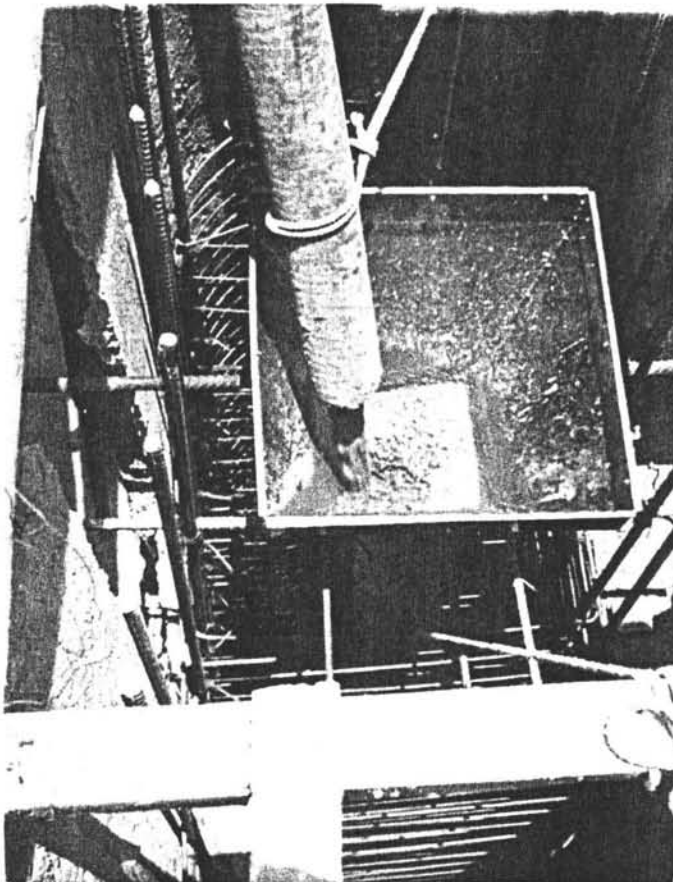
Colado de una de las pilas oblongas.
